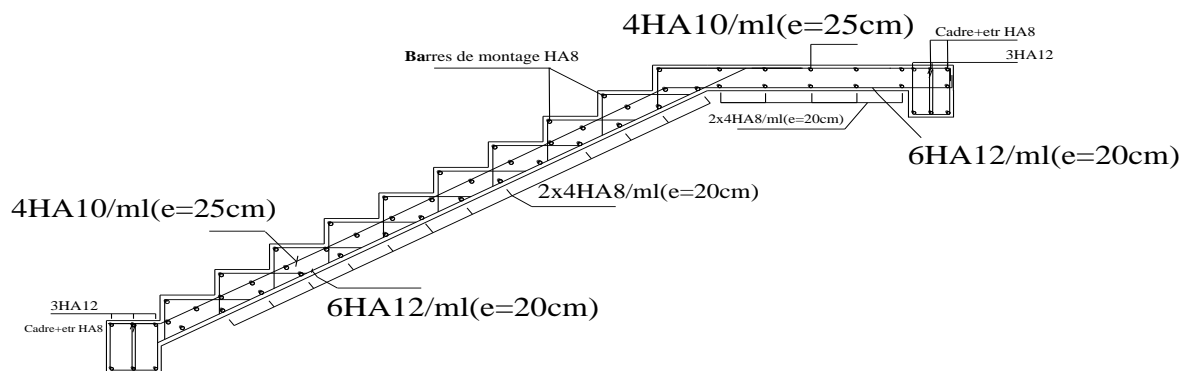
Schéma de ferrailage des escaliers RDC et sous-sol.
